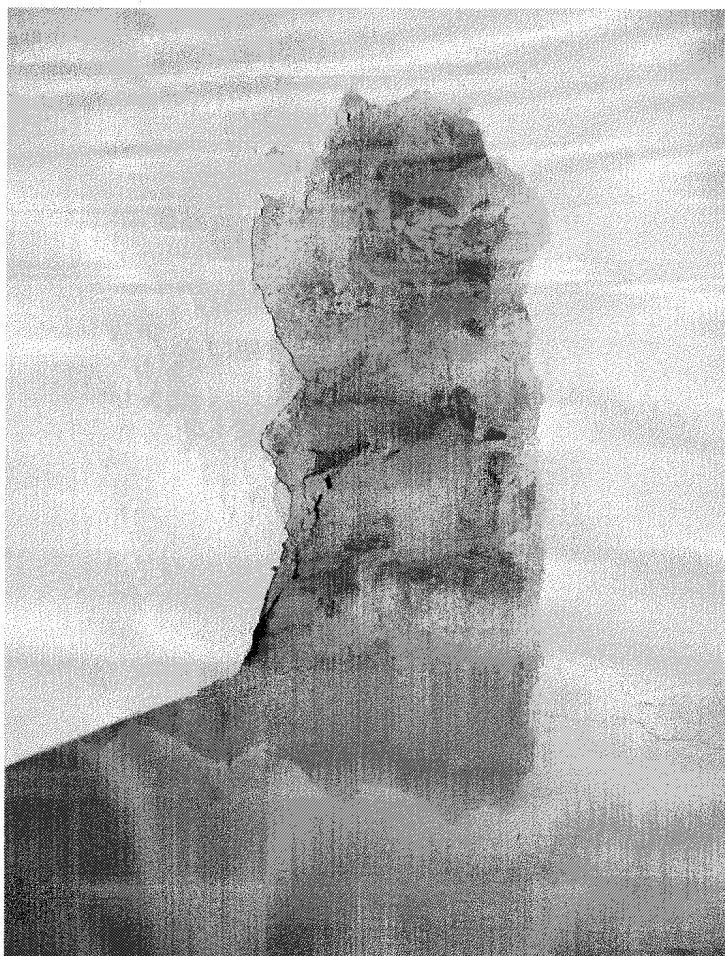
Inserimento a muro di una trave principale della copertura del piano Terra
